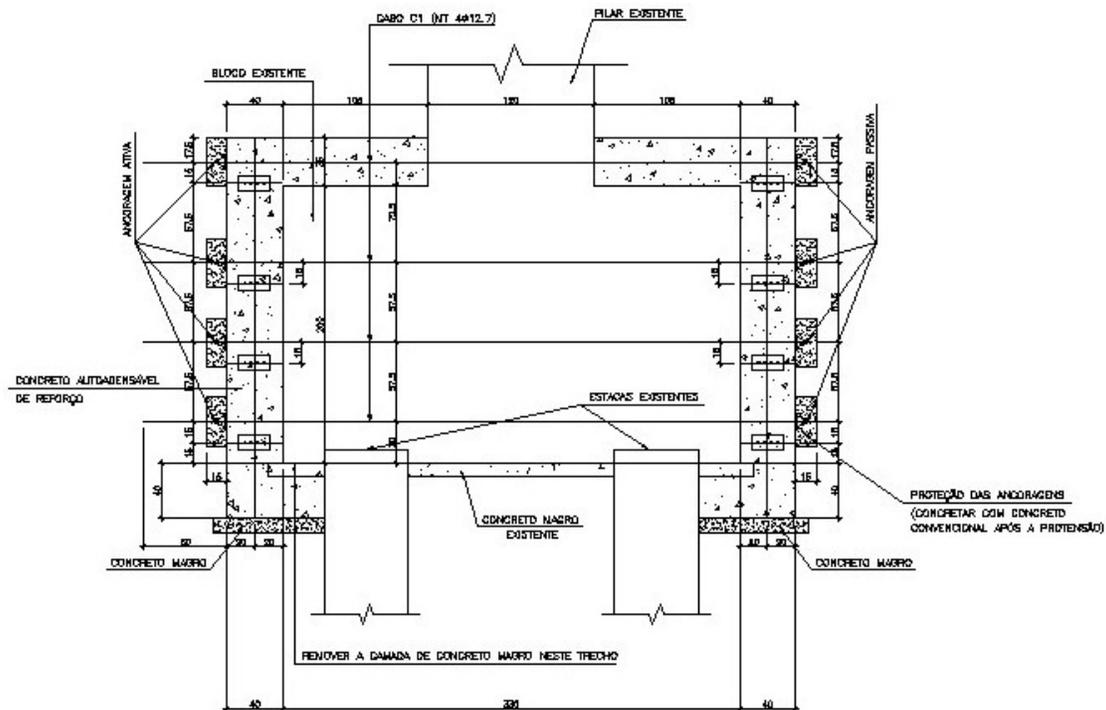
Detalhe do reforço do bloco com concreto auto adensável e protensão com cabos horizontais ao longo do perímetro.
